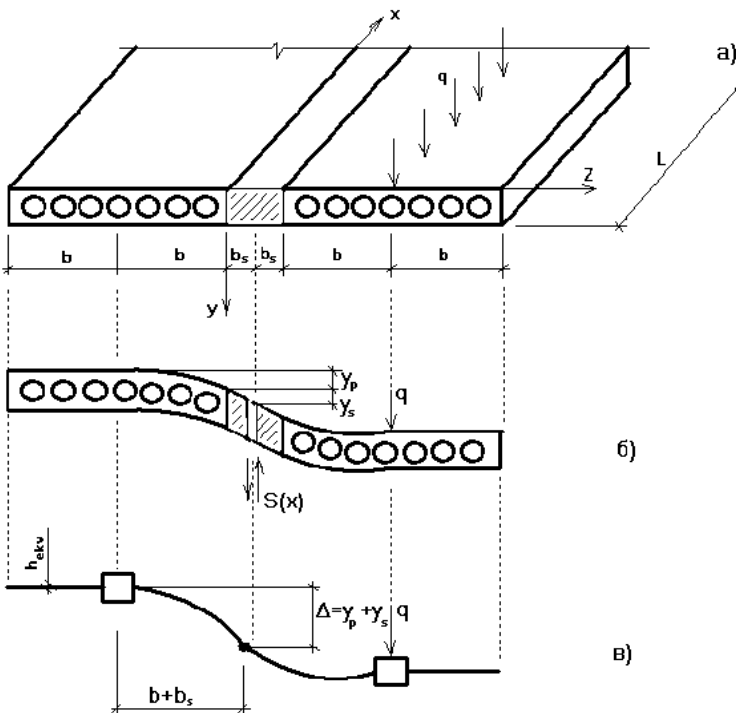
Розрахункова схема перекриття з врахуванням згину плит в поперечному напрямку: а) реальна схема; б) схема деформованого поперечного перерізу перекриття; в) розрахункова схема
